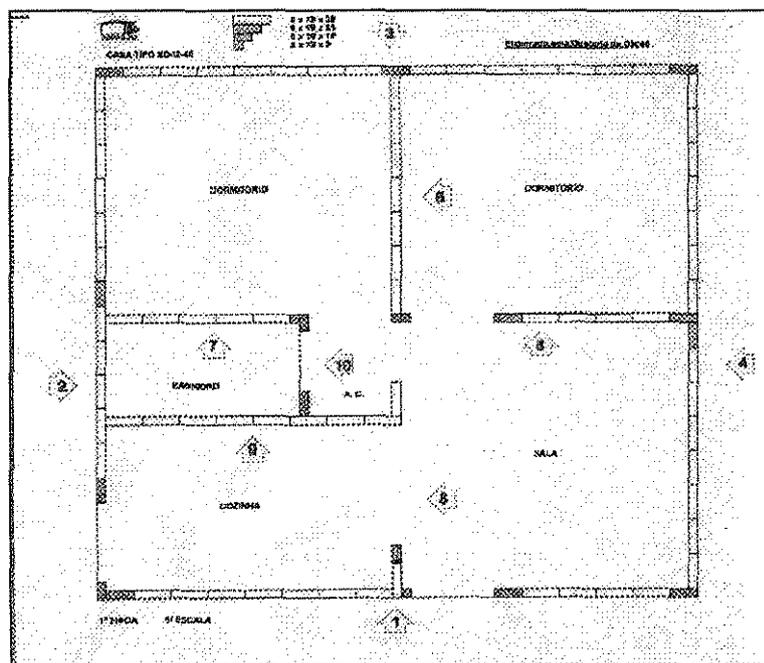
Modulação do projeto arquitetônico - primeira fiada
